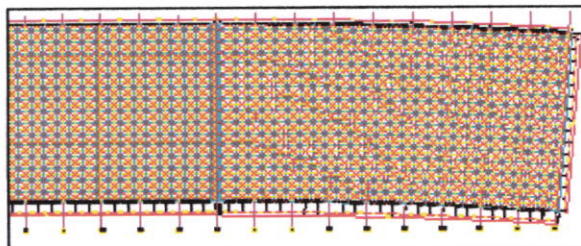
Vue en plan du projet ; source : <http://www.archistructur.org>
